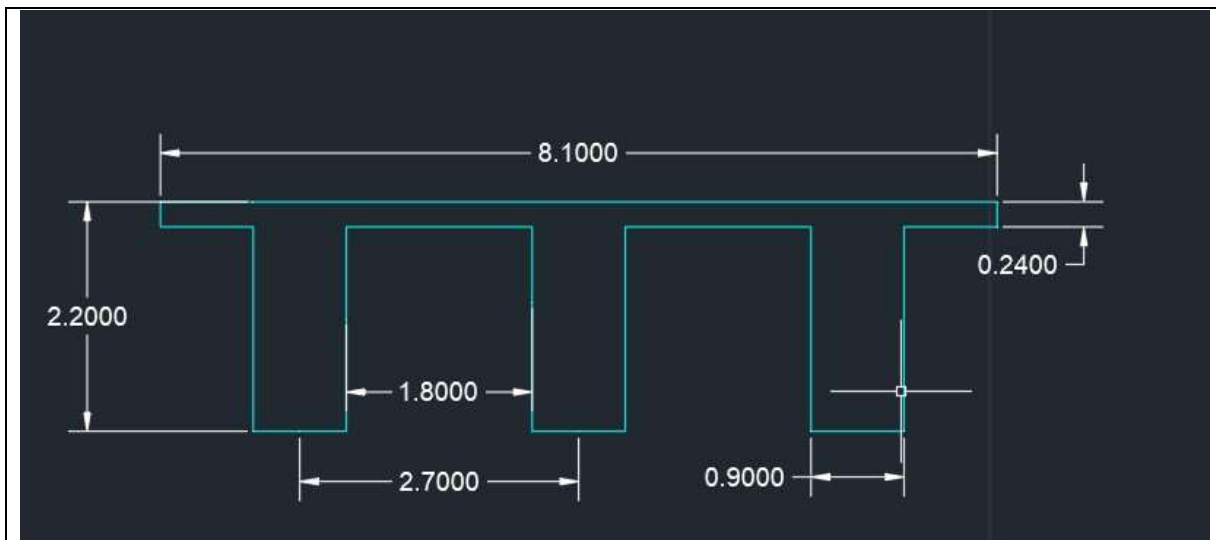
Elaboración Propia Predimensionamiento de Viga tee
